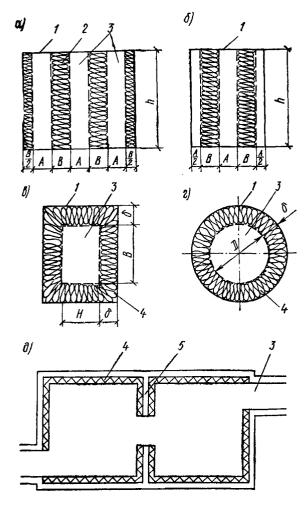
Схемы конструкций глущителей а— пластинчатый с крайними пластинами; б— пластинчатый без крайних пластин; в— трубчатый прямоугольного сечения; г— трубчатый круплого сечения; д— камерный; г— кожух глушителя; г— звукопоглощающая пластина; з— каналы для воздуха; т— звукопоглощающая облицовка; б— внутренняя перегородка
